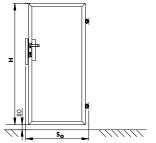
Схема конструкции калитки для индивидуального заполнения - вид со стороны улицы.
